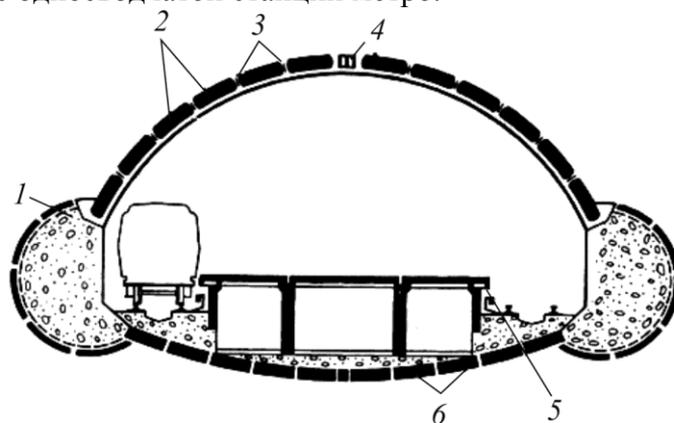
Поперечное сечение односводчатой станции глубокого заложения из сборного железобетона: 1 – бетонные опоры сводов тоннеля, 2 – железобетонные блоки верхнего свода, 3 – прокладки между блоками, 4 – разжимный блок, 5 – платформа, 6 – железобетонные блоки обратного свода
